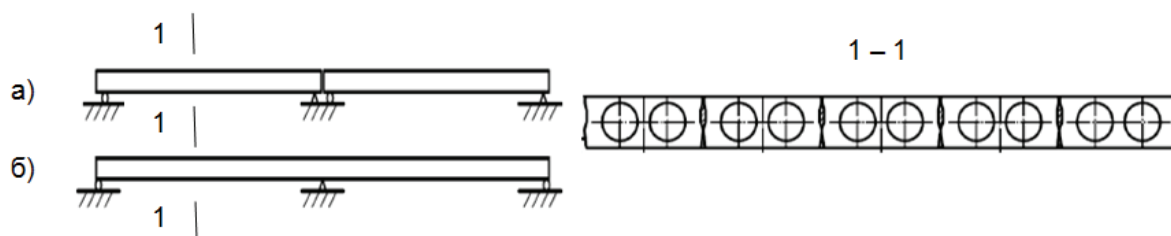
Расчетные схемы (разрезная – а, неразрезная – б) и фрагмент сечения пролетного строения из пустотных плит
